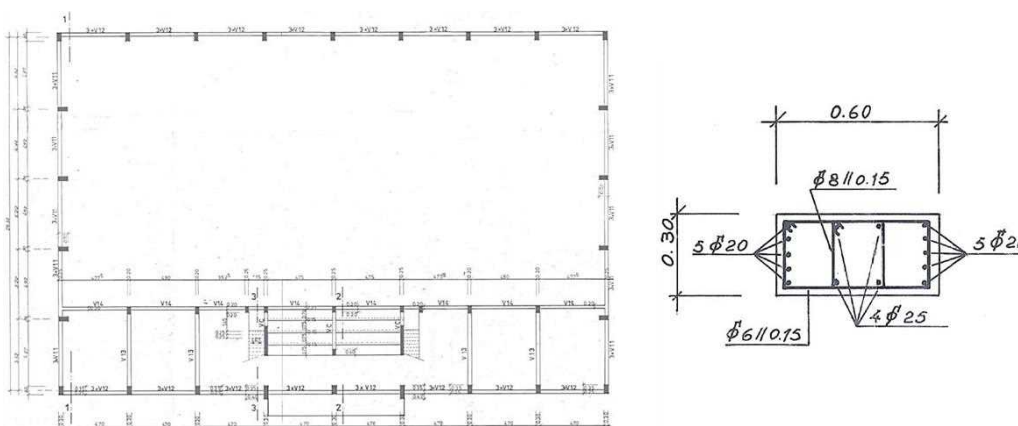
Planta do pavilhão tipo SC (à esquerda) e pormenor de pilar P8 (à direita).
